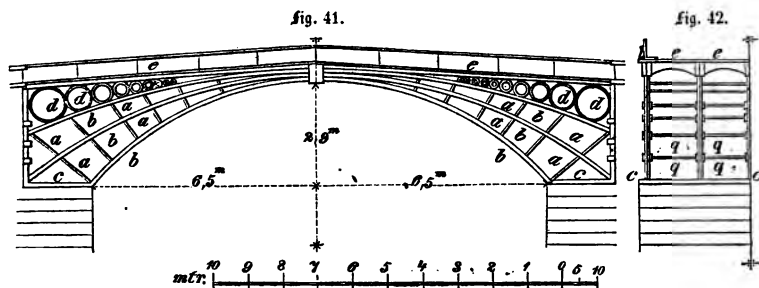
und 42. Gußeiserne Brücke über das Strigauer Wasser zu Laasan.
